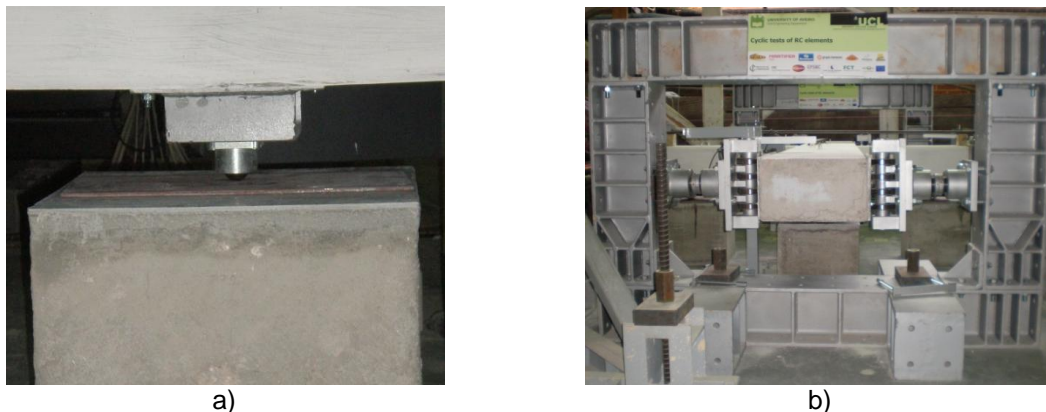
a) mecanismo de esfera com apoio; b) apoio simples da viga;
